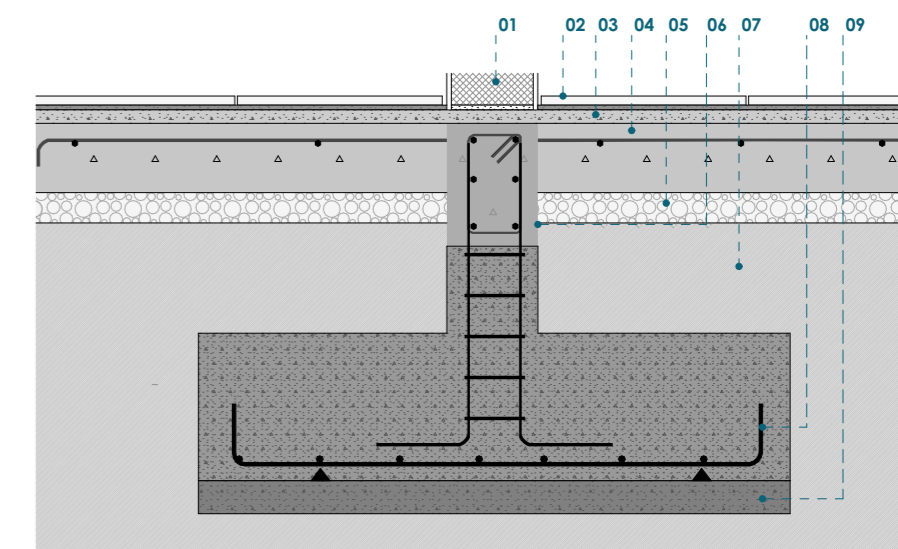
Detalle cimentación. Fuente: Elaboración propia.
